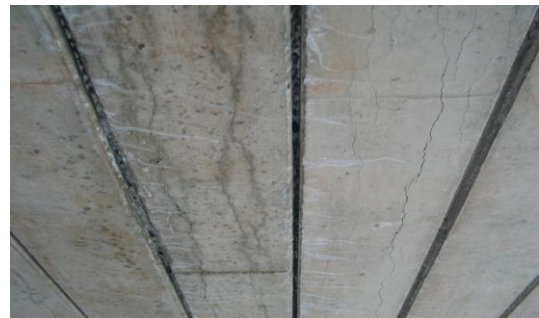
ASRが発生したPCホロー桁のひび割れ(底面)
